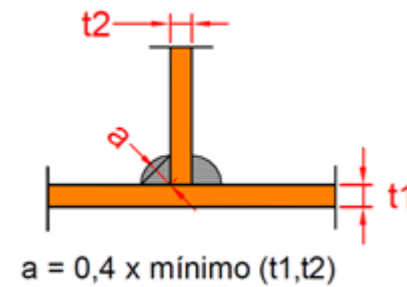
Soldaduras del perfil metálico
